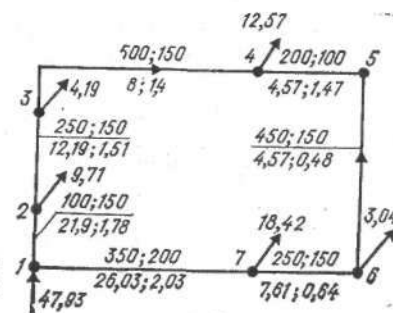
Расчетная схема наружной водопроводной сети до пожара
